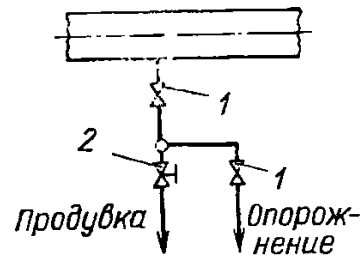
Схема выполнения дренажного узла на паропроводе низкого давления:
